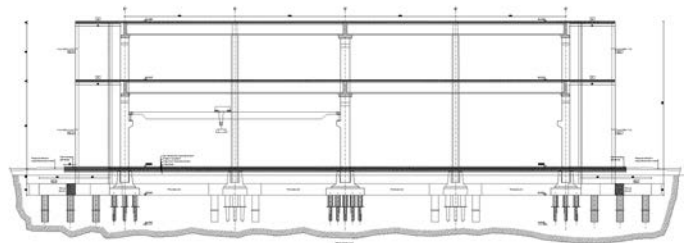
Sezione trasversale dell'intervento di adeguamento.
